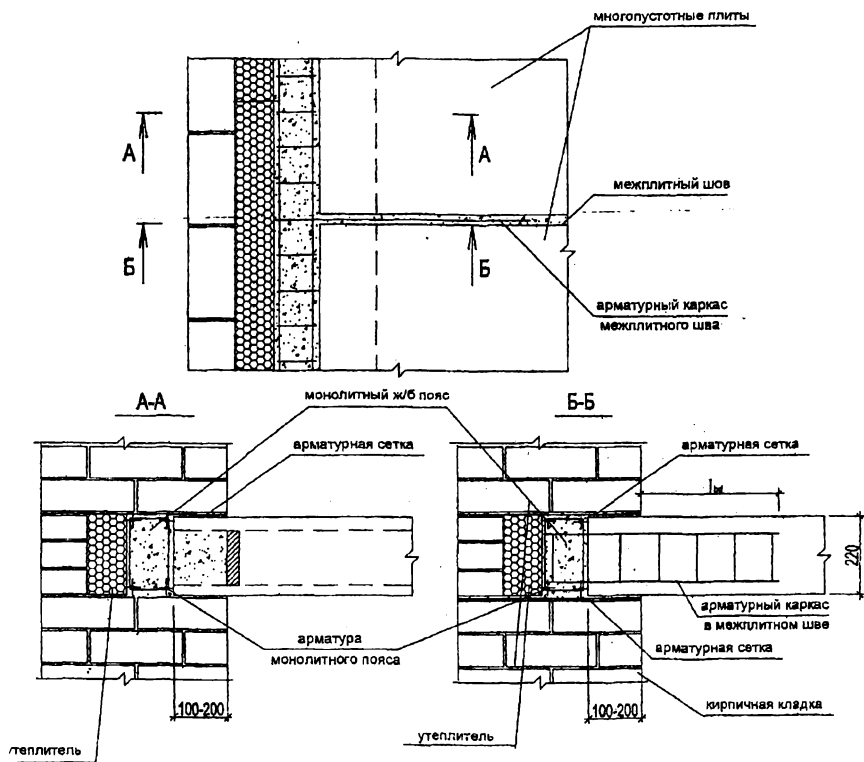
Схема опирания плит безопалубочного формирования на кирпичную кладку с устройством монолитного пояса
